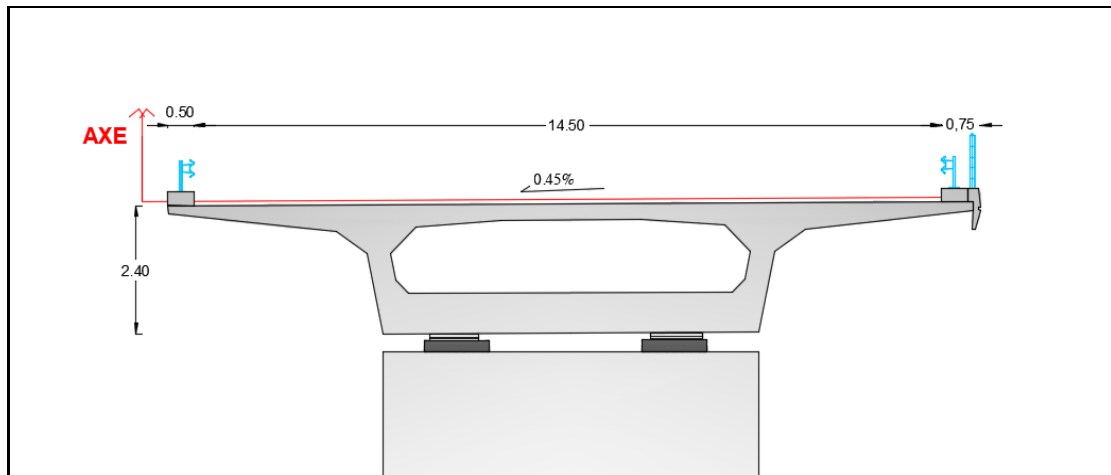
Coupe transversale sur le tablier au niveau de la pile.
